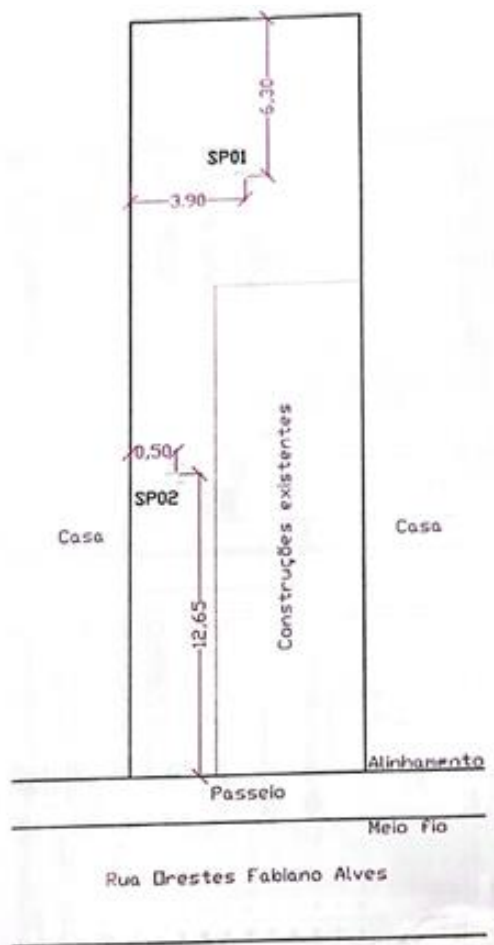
Planta de Locação (Croqui) dos Furos de Sondagens Realizados.
